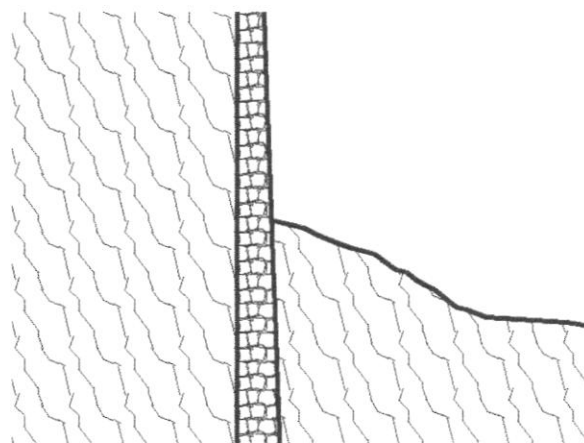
Coupe schématisé sur les fondations.⁴⁶
